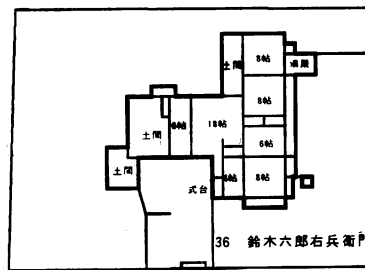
享保6年所司代下屋敷絵図の中型住宅平面図
